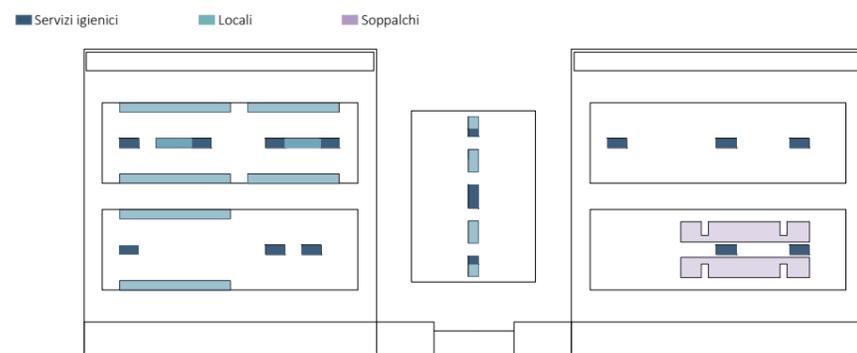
Planimetria Piano Terra- Spazi mantenuti (elaborazione personale, 2022)
